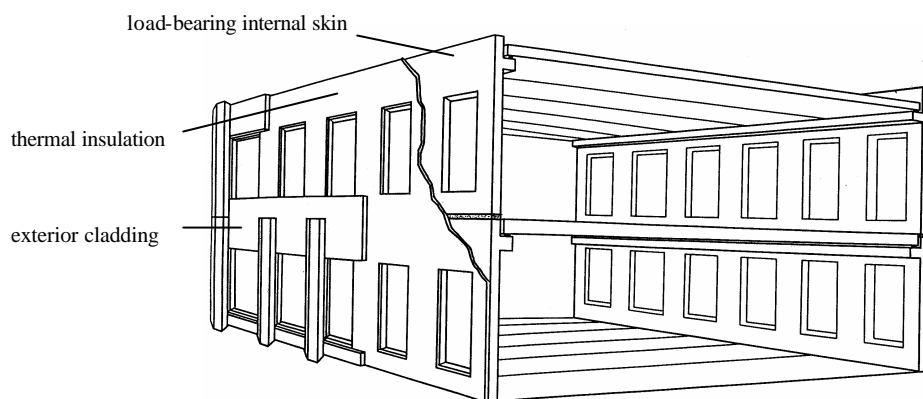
Princípio de sistemas com “pele dupla” para fachadas
